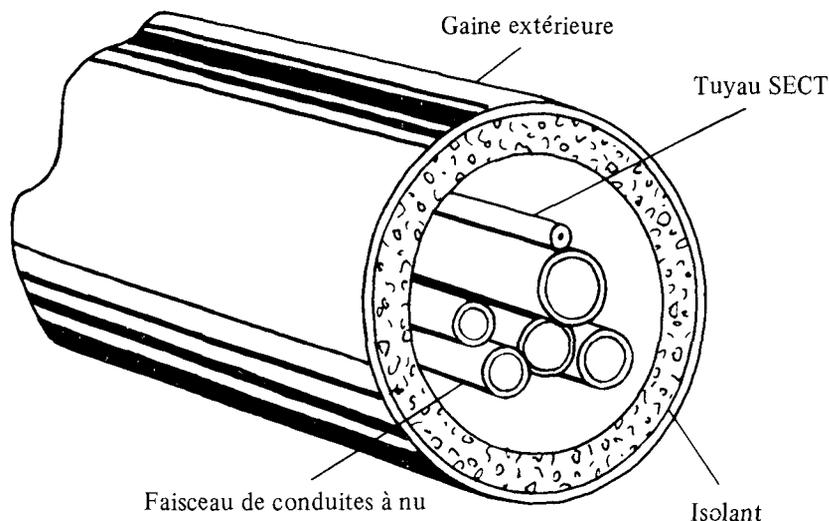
Faisceau de conduites à nu et tuyau SECT dans un conduit commun isolé
